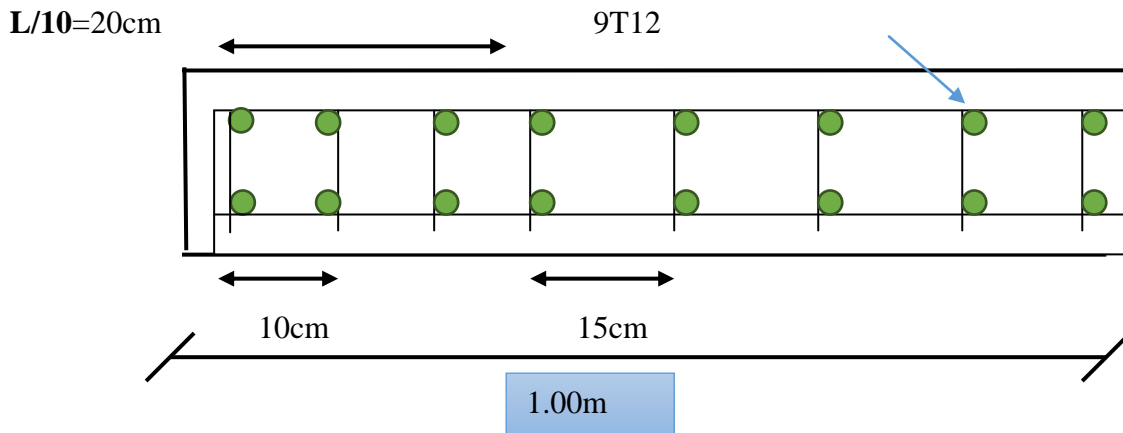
SCHEMA DE FERRAILLAGE (1/2 voile)
